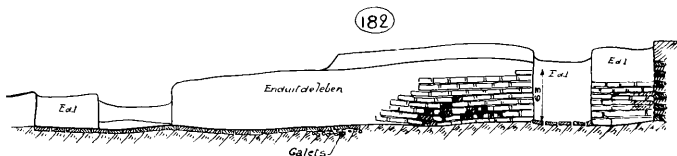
Salle 182. Coupe du mur nord, avec fondations en briques cuites.
